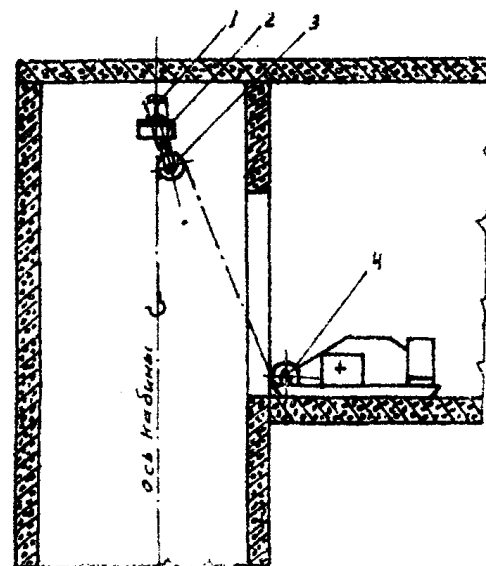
Установка монтажной лебедки на посадочной площадке верхнего этажа:
